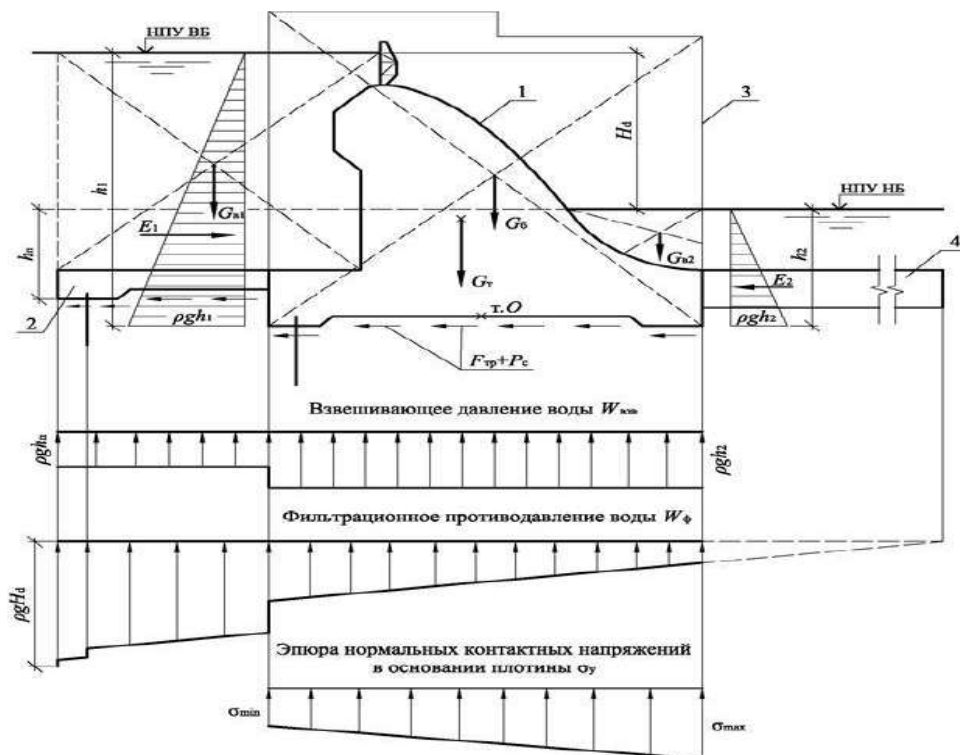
Расчёт устойчивости на плоский сдвиг бетонной плиты
